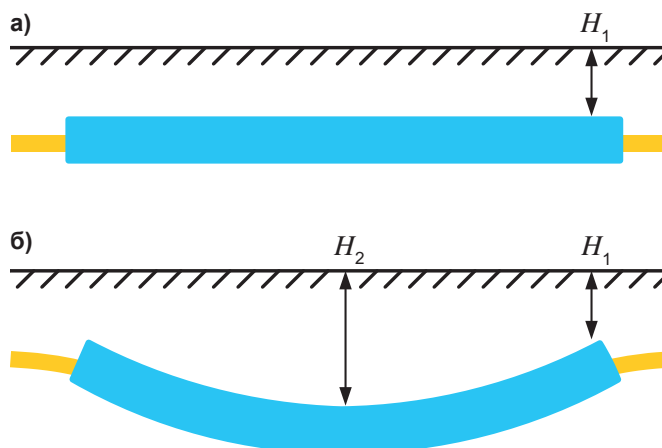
Прокладка кабеля в полимерной трубе в грунте: а) труба размещена на дне траншеи; б) труба затянута в грунт методом ГНБ
